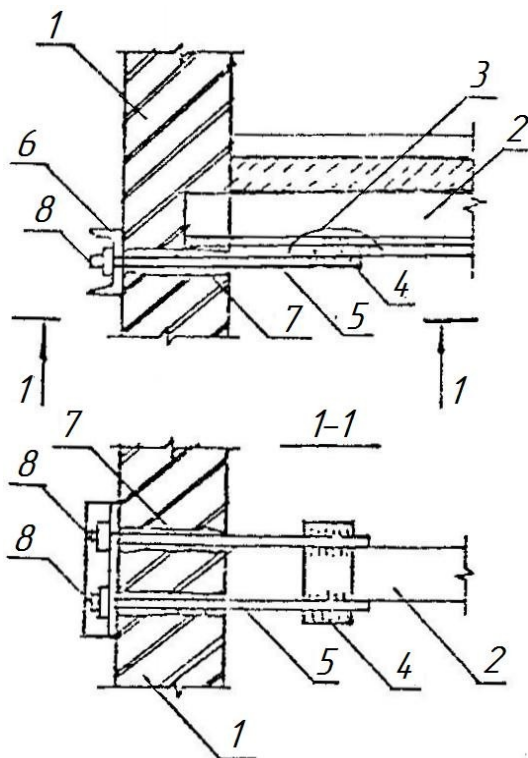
Посилення вузлів сполучення цегляних стін з'єднанням зовнішніх стін з балками перекриття тяжами: 1 – зовнішня стіна; 2 – залізобетонна балка перекриття; 3 – оголена робоча арматура балки; 4 – пластина, приварена до оголеної арматури балки; 5 – тяжі, приварені до пластин; 6 – прокладка-шайба для укріплення отворів; 7 – отвори в стінах; 8 – гайки для натягу
